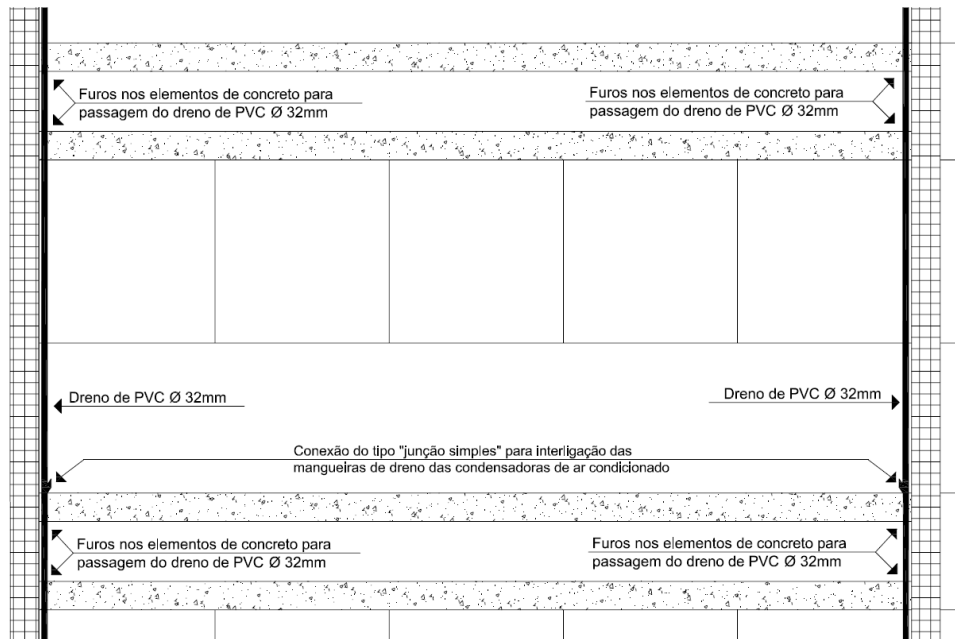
Vista da rede de drenos em pavimento tipo a ser instalada em cada vão
